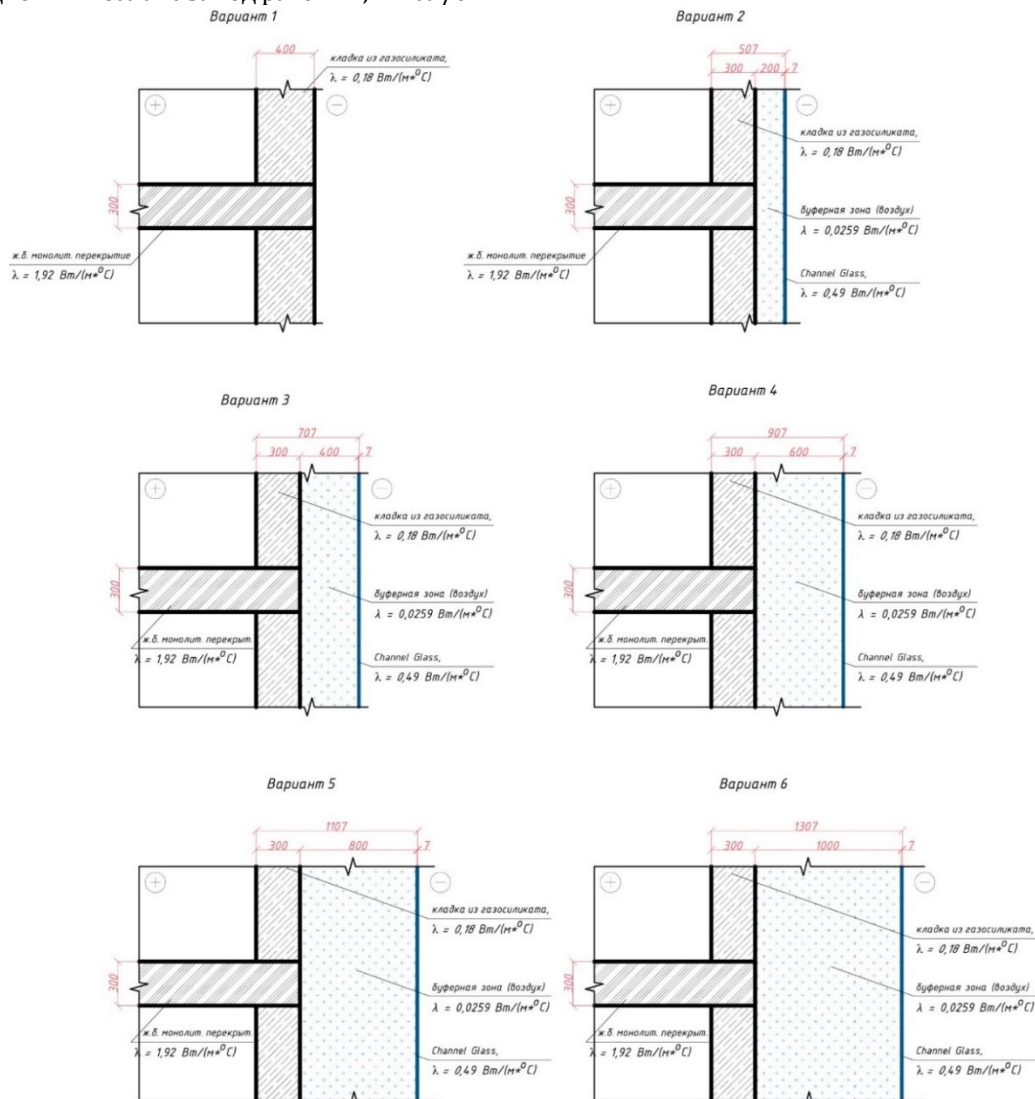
Варианты конструкции узла перекрытие – наружная стена
